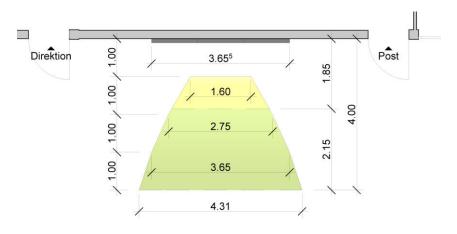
Kinect Skelett-Erkennungsbereich, Grundriss Verwaltungsgebäude
